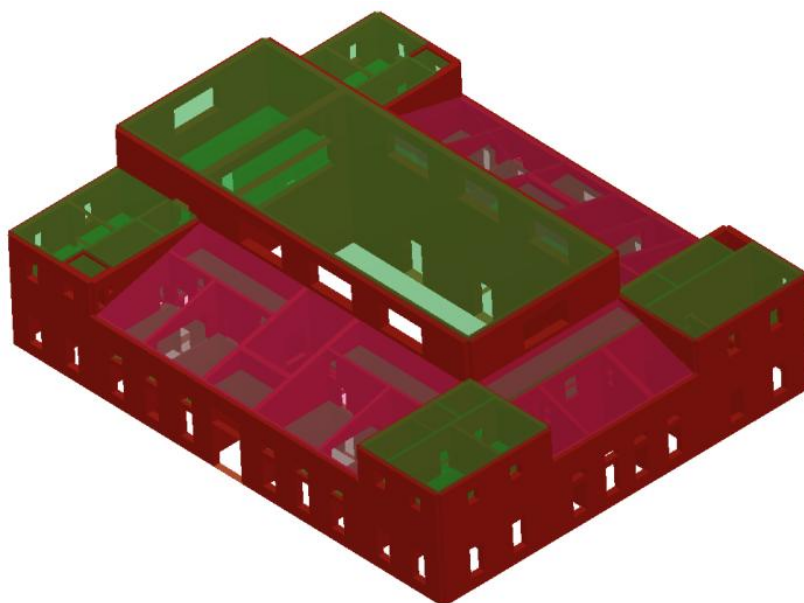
Vista tridimensionale - Prospetto est su via Coccapani e Prospetto sud lato cortile
